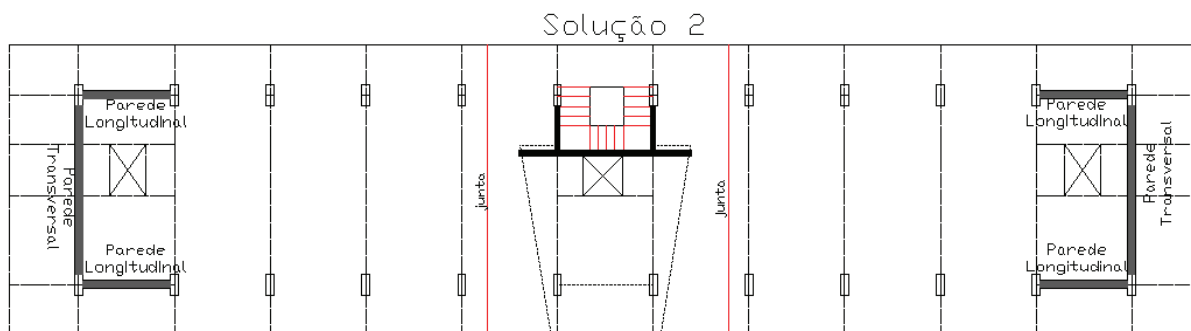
Disposição em planta da localização da implantação das paredes resistentes para a solução 2 - Edifício Lisboa.
